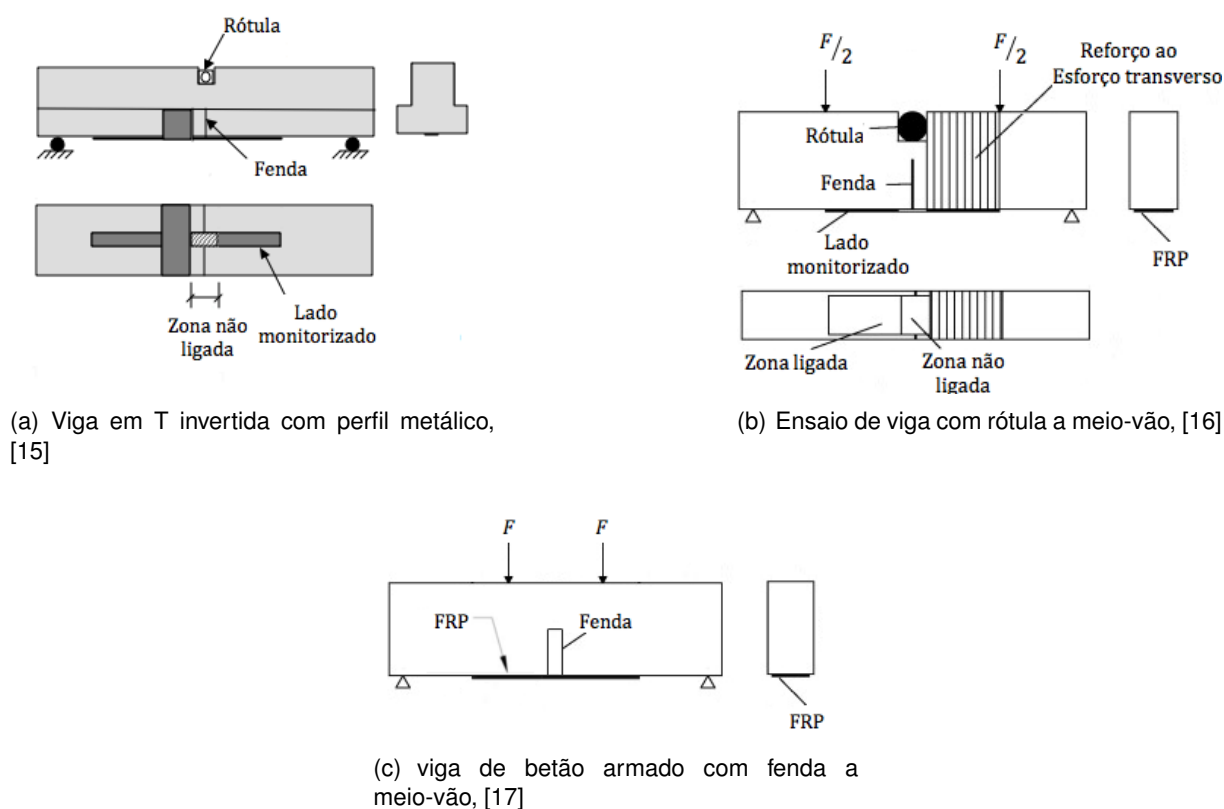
Diferentes esboços para ensaio de viga de betão armado com fenda a meio vão
